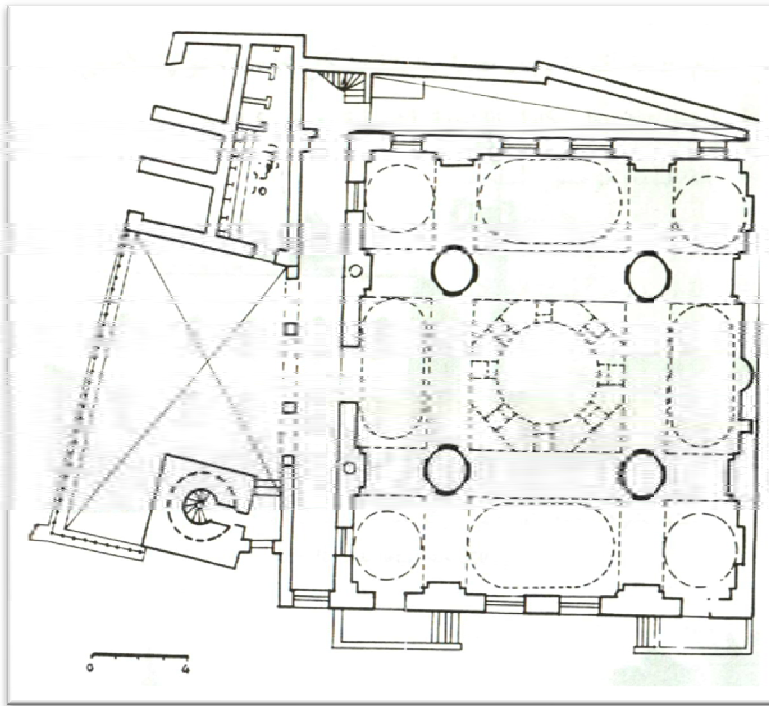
مخطط الطابق العلوي لجامع رشيد باشا (عن الفقيه)
